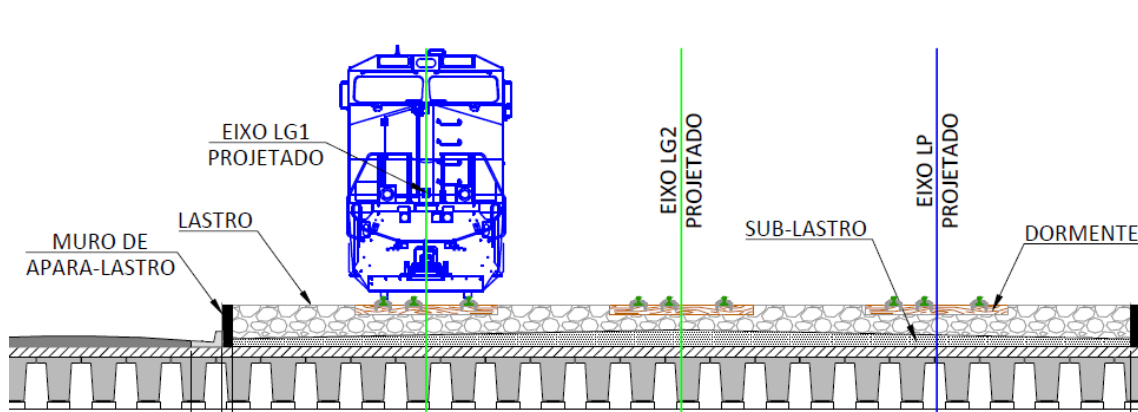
Representação das camadas de Lastro e Sublastro da via férrea.
